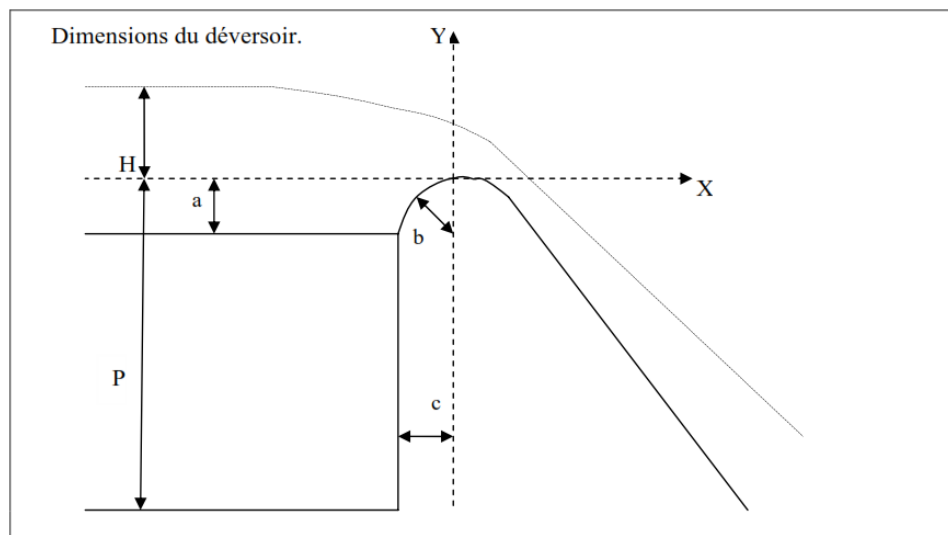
Dimensions caractéristiques et géométrie du déversoir
